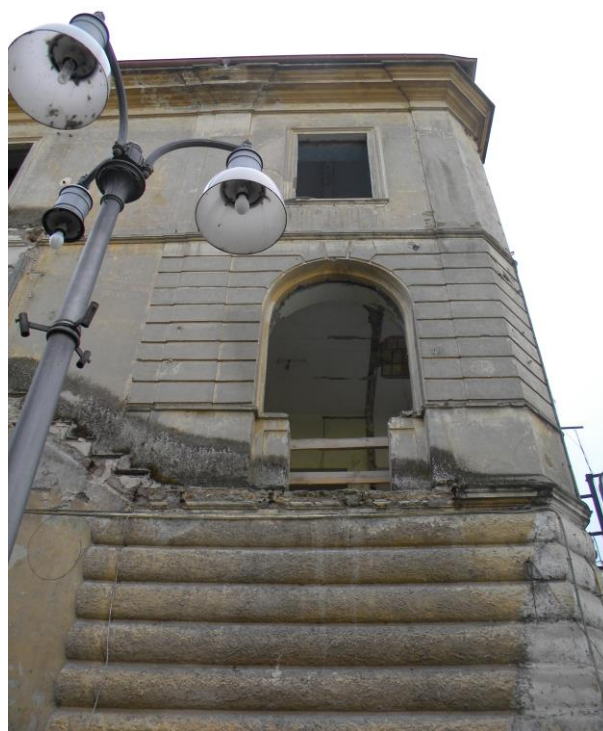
Facciata est – elemento angolare in intonaco bugnato e apertura ad arco a tutto sesto
